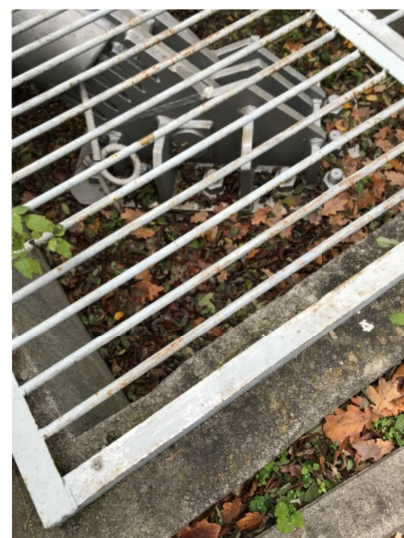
Ślady rdzy przy elementach stalowych mocowania elementów elewacyjnych
